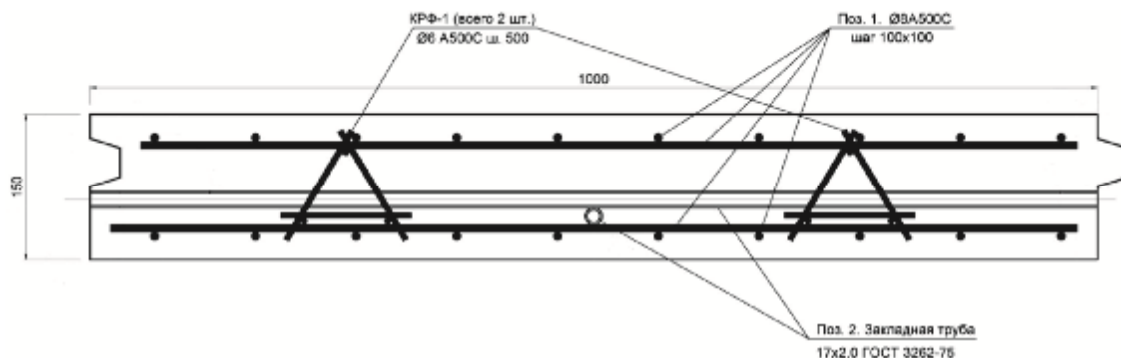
Вариант выполнения арматурного каркаса плиты ССП BAK_j
